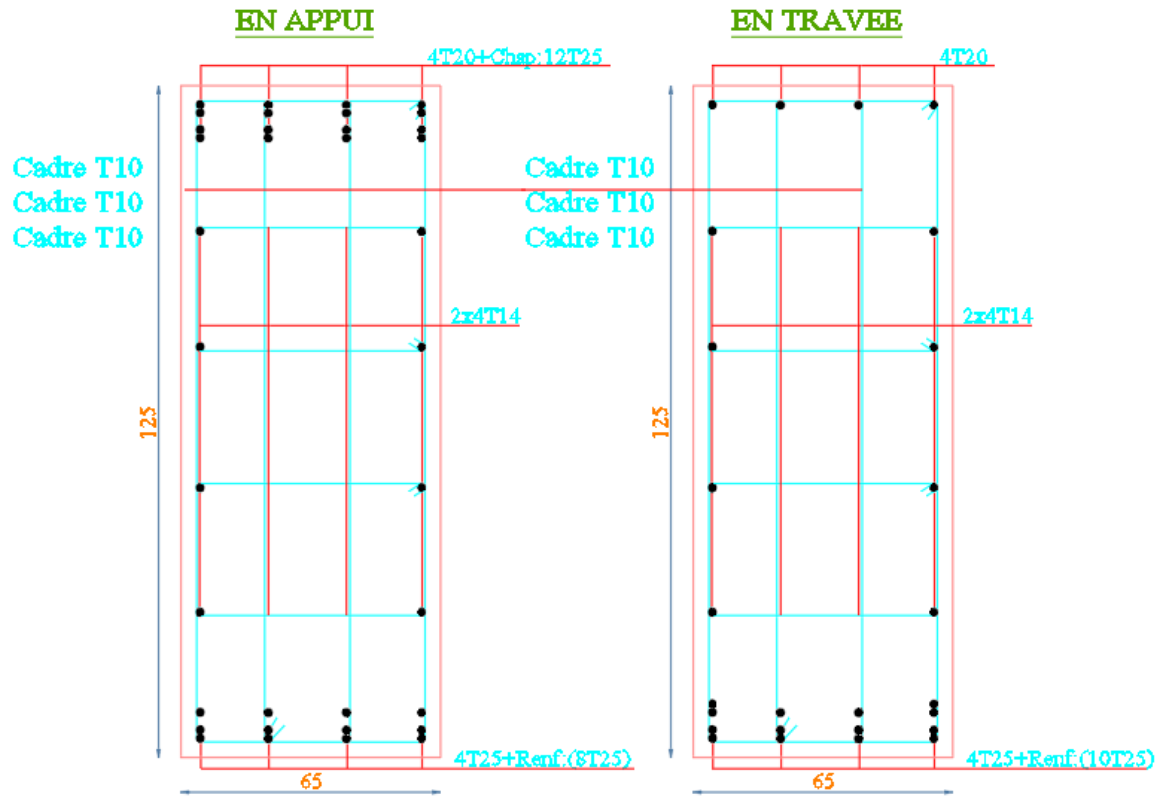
Schéma du ferrailage de la poutre principale 125*65
